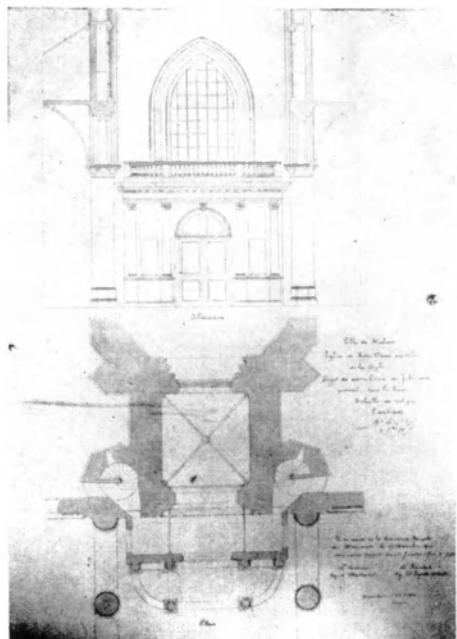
Elévation et plan du jubé. (Archives de l'église, plan n° 25).
